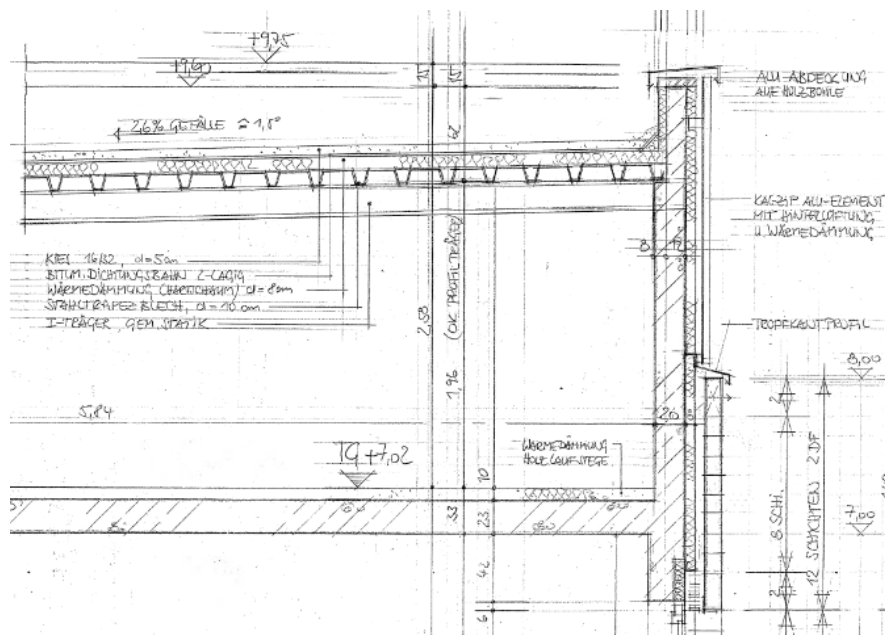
Auszug Fassadendetail Regelaufbau mit Übergang ins Technikgeschoss
